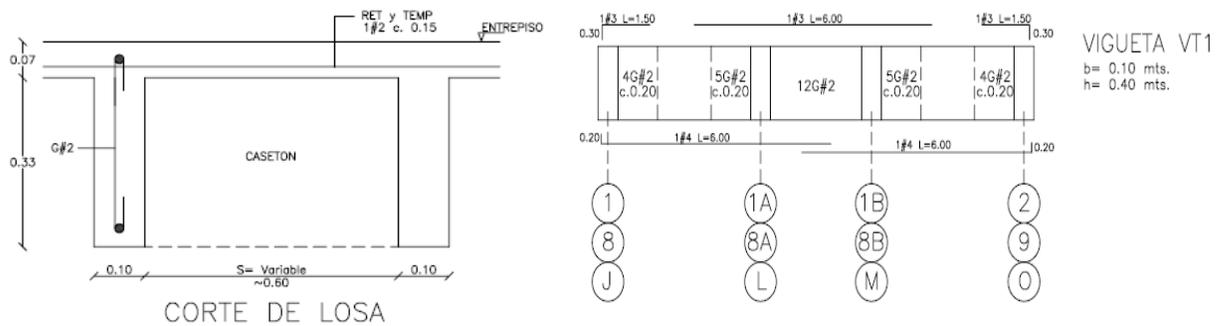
Sección típica sistema de entepiso y detalle del refuerzo vigueta VT1
